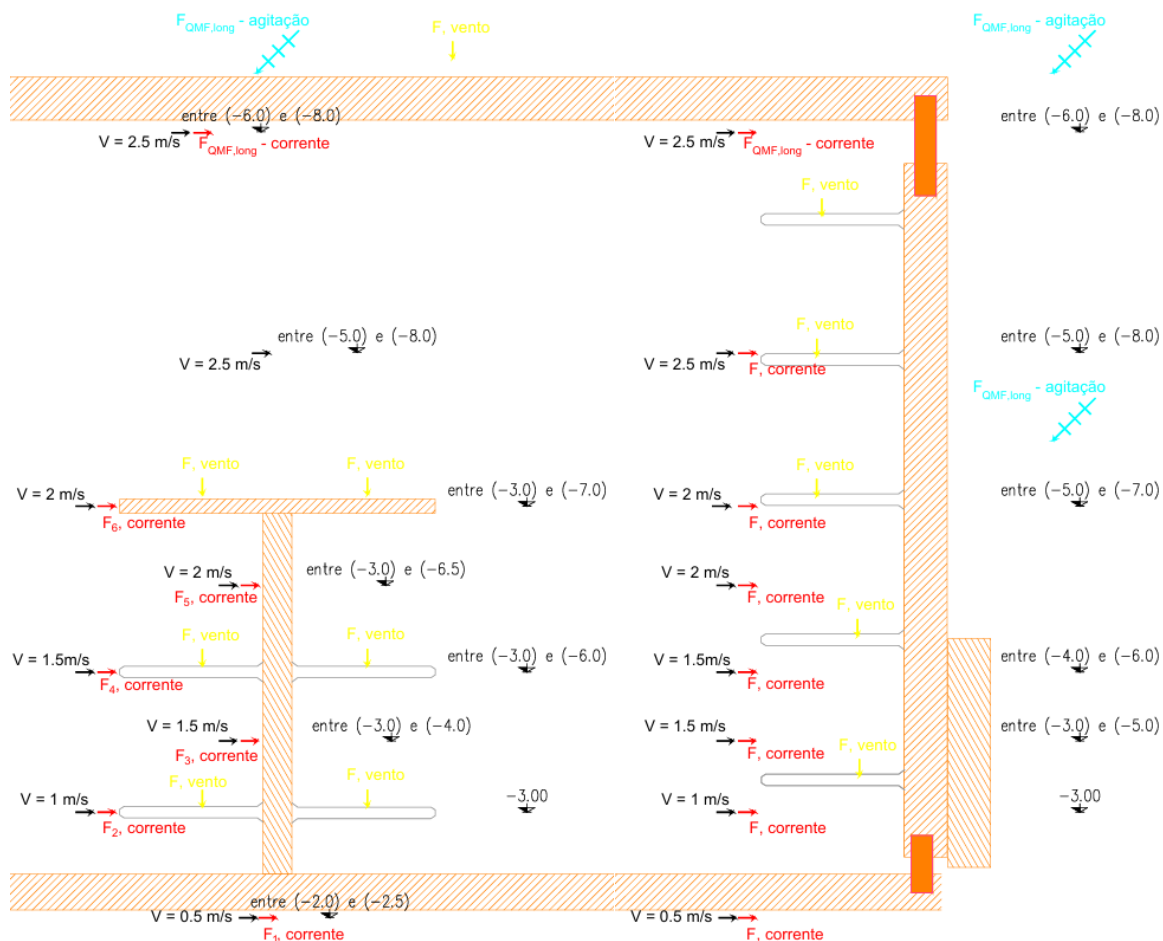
Desenho esquemático da atuação das forças sobre as estacas de guiamento – planta
